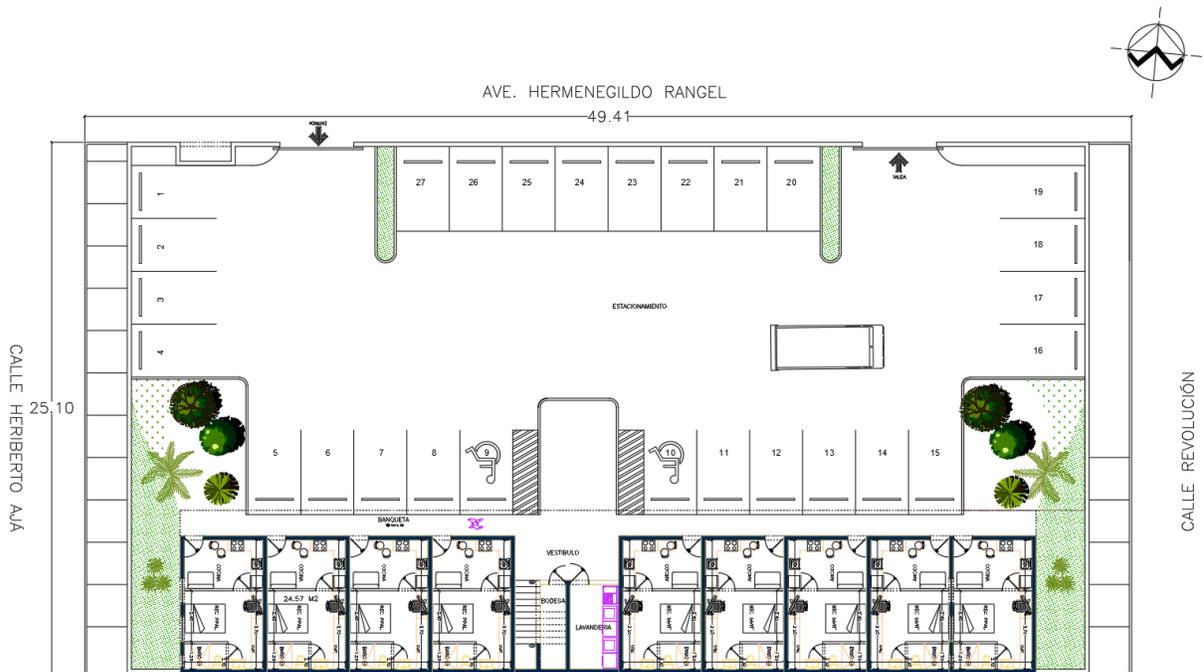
V.34 Planta arquitectónica esquemática de proyecto de departamentos
